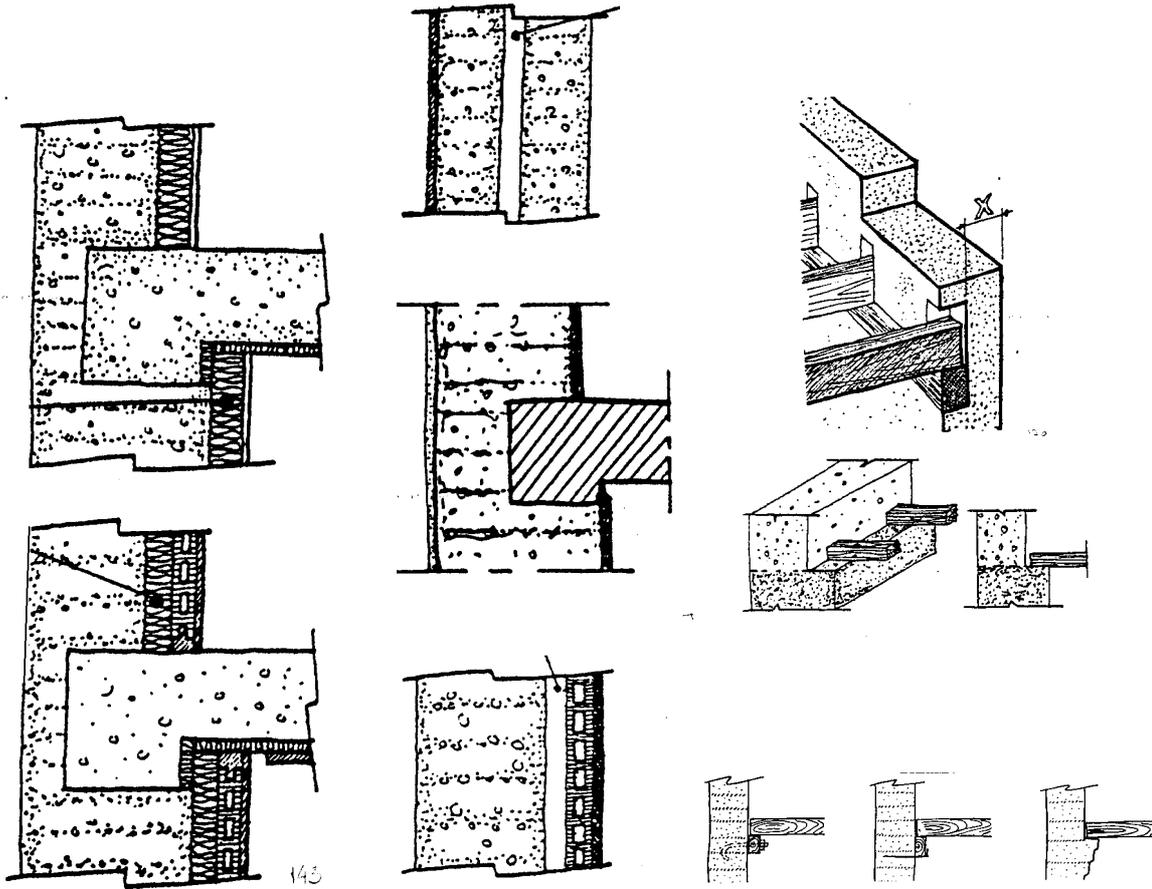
Detalles de aislamientos con placas y cámara para el tapial. A la derecha sistemas de apoyo de biguetas de madera sobre muro.
